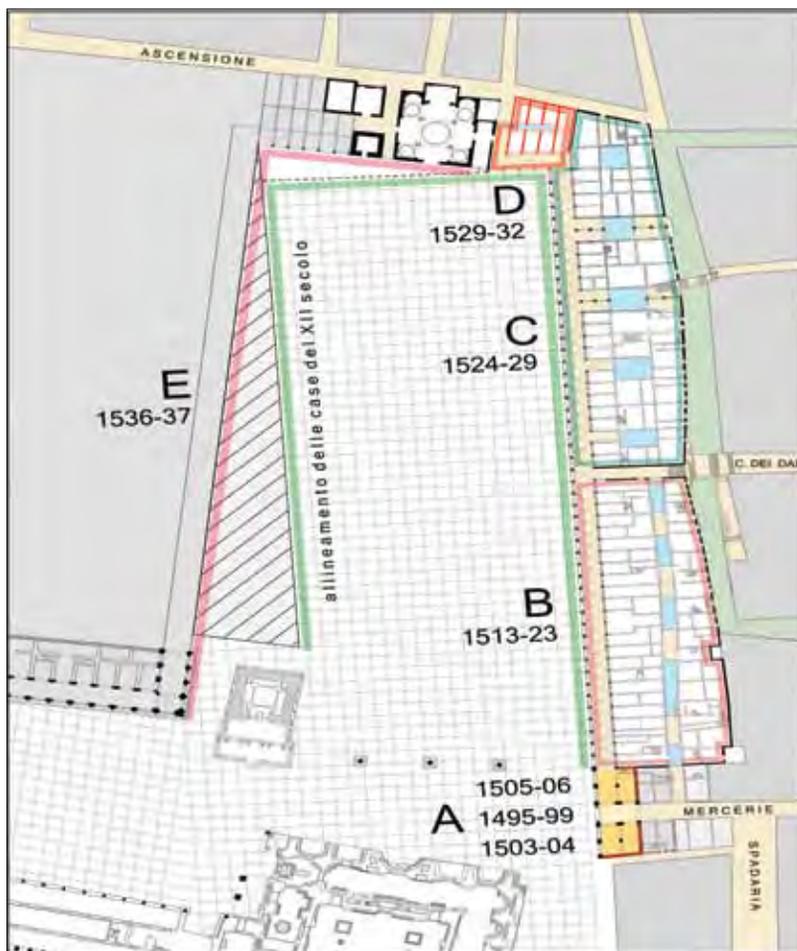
Planimetria della platea marciana*: A) Torre delle Ore e le sue “ali”; B) Cantiere di *renovatio* diretto dal proto Pietro Bon; C) Variante su proposta di Jacopo Sansovino; D) Cantiere di *renovatio*, diretto dal proto J. Sansovino; Segno verde: configurazione della platea marciana conseguente al progetto di J. Sansovino del 1529. Segno rosa: configurazione della platea marciana conseguente al proponimento di J. Sansovino del 1536-37.
